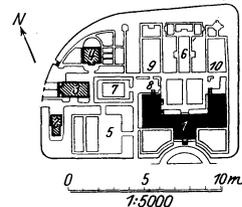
Bergedorf, Krankenhaus für 75 Betten. 1 Hauptgebäude. 2 Leichenhalle. 3 Waschhaus. 4 Wohnhaus. 5 Wäschetrockenplatz. 6 Schwestergarten. 7 und 8 Garten für ansteckende Kranke. 9 Männergarten. 10 Frauengarten.
